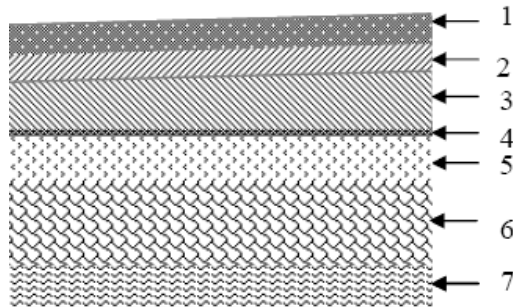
Coupe transversale du plancher terrasse inaccessible
